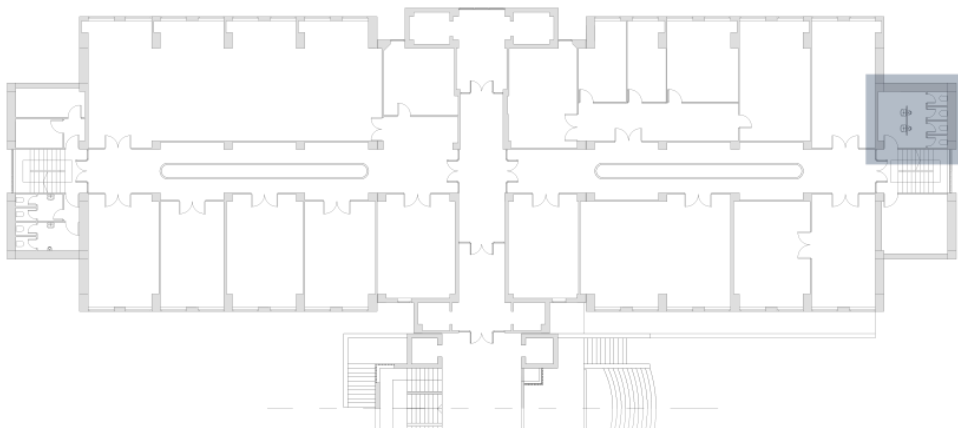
Planta 3ª Edificio de Dirección e Investigación (Elaboración propia)
